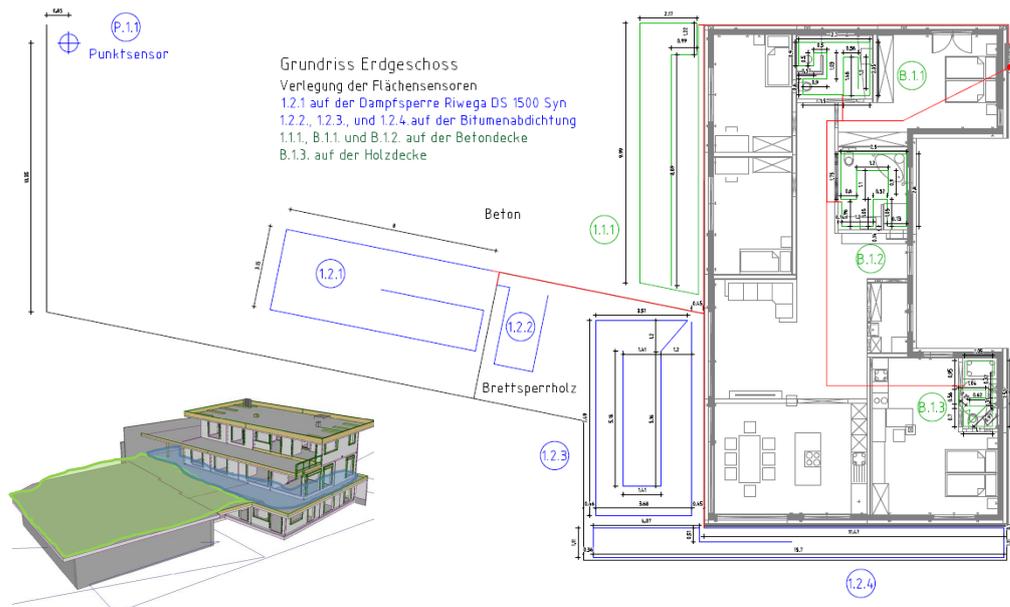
Erdgeschoss – Bandsensoren auf Abdichtungsbahnen (blau) – auf den Rohdecken (Stahlbeton und Brettsperholz; grün) Punktsensor – eingeschossiges Bestandsgebäude
